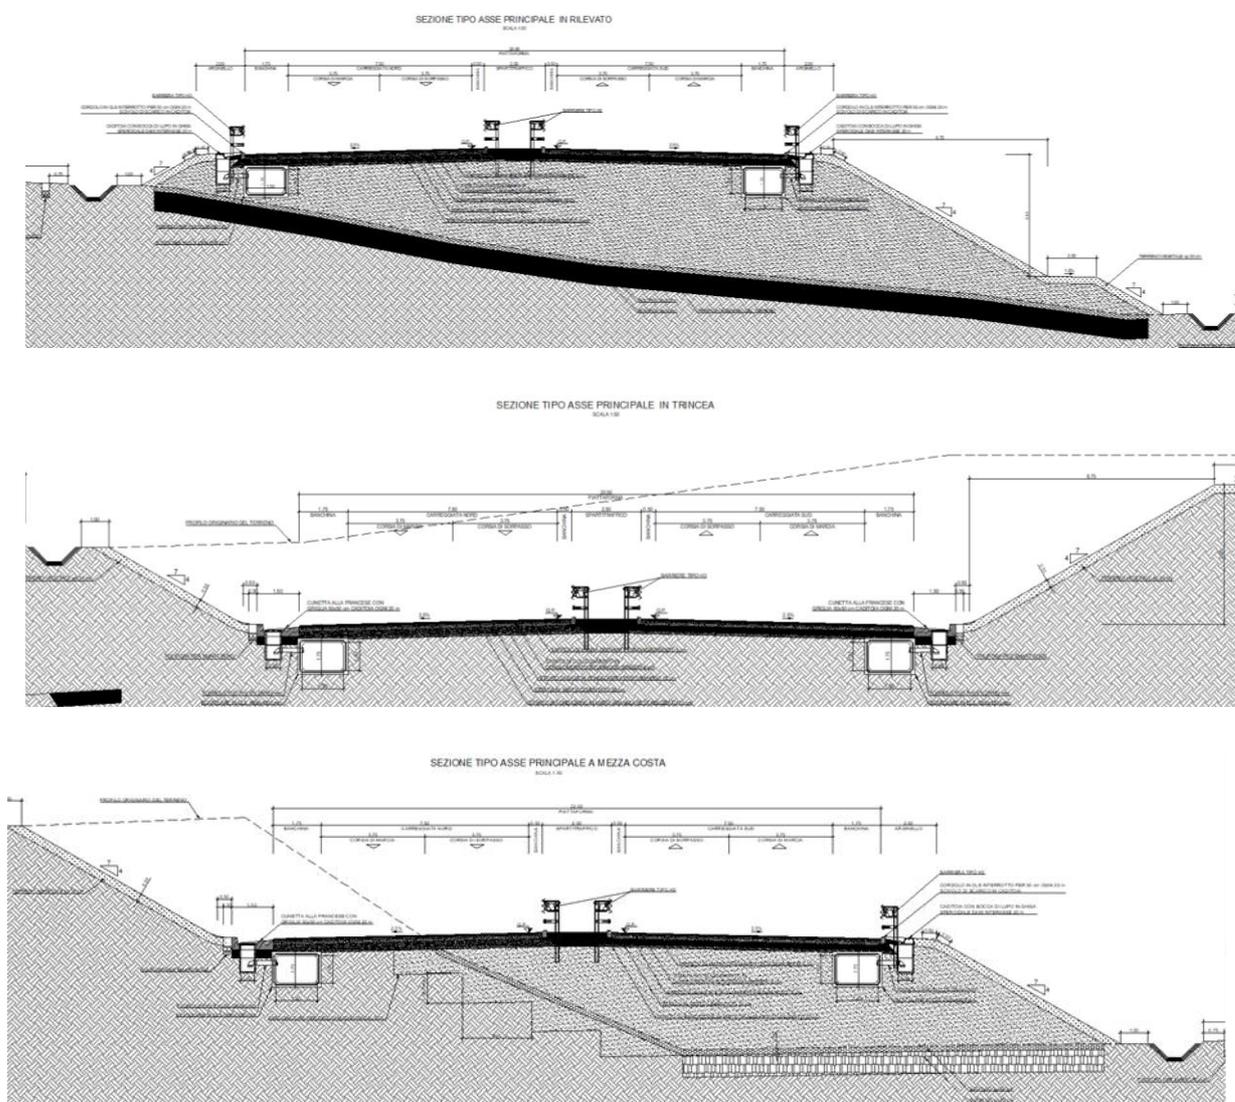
Sezioni tipo asse principale secondo le tipologie dalla sezione stradale in alto verso il basso: sezione tipo asse principale in rilevato, sezione tipo asse principale in trincea, sezione tipo asse principale a mezza costa.
